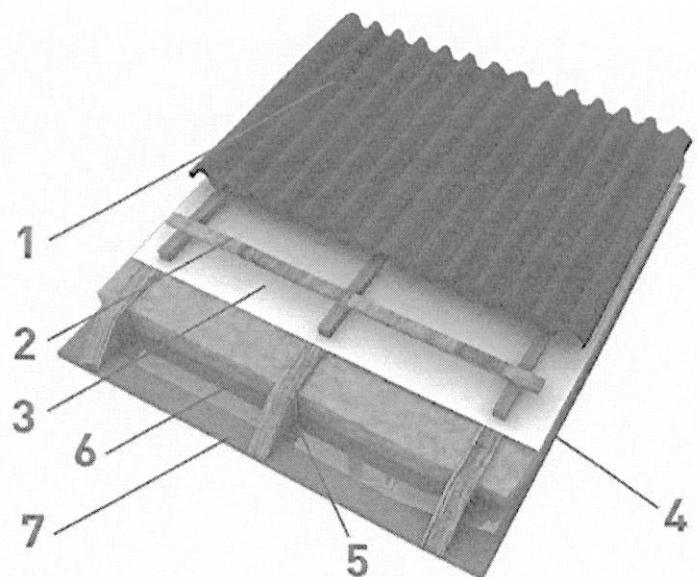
Структура скатной кровли: 1 – черепица или другой кровельный материал; 2 – шаговая (поперечная) обрешетка; 3 – ветро- и влагозащитная мембрана; 4 – слой утеплителя; 5 – стропила; 6 – слой пароизоляции; 7 – слой внутренней отделки
